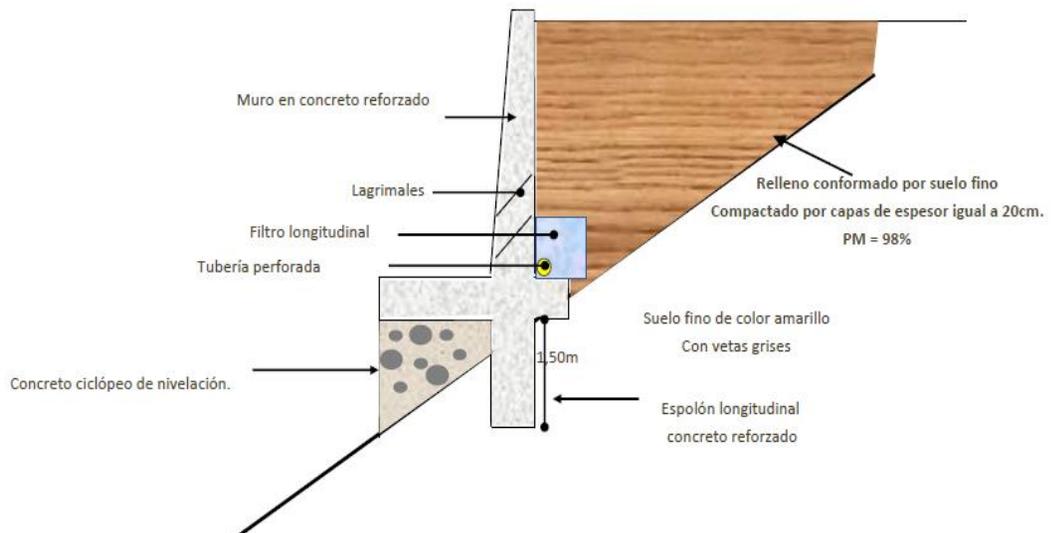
Propuesta de cimentación, muro convencional concreto reforzado
